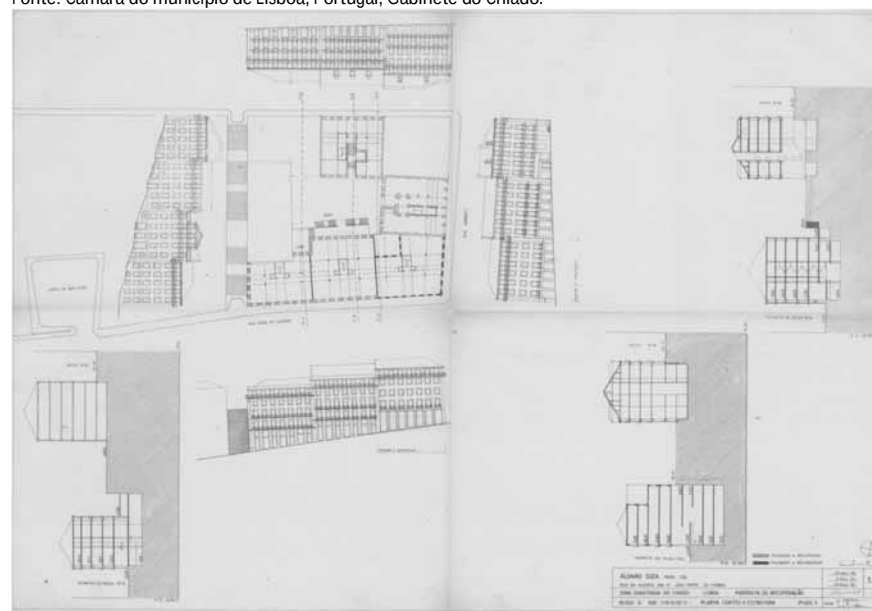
Planta e cortes, proposta de recuperação do bloco A
